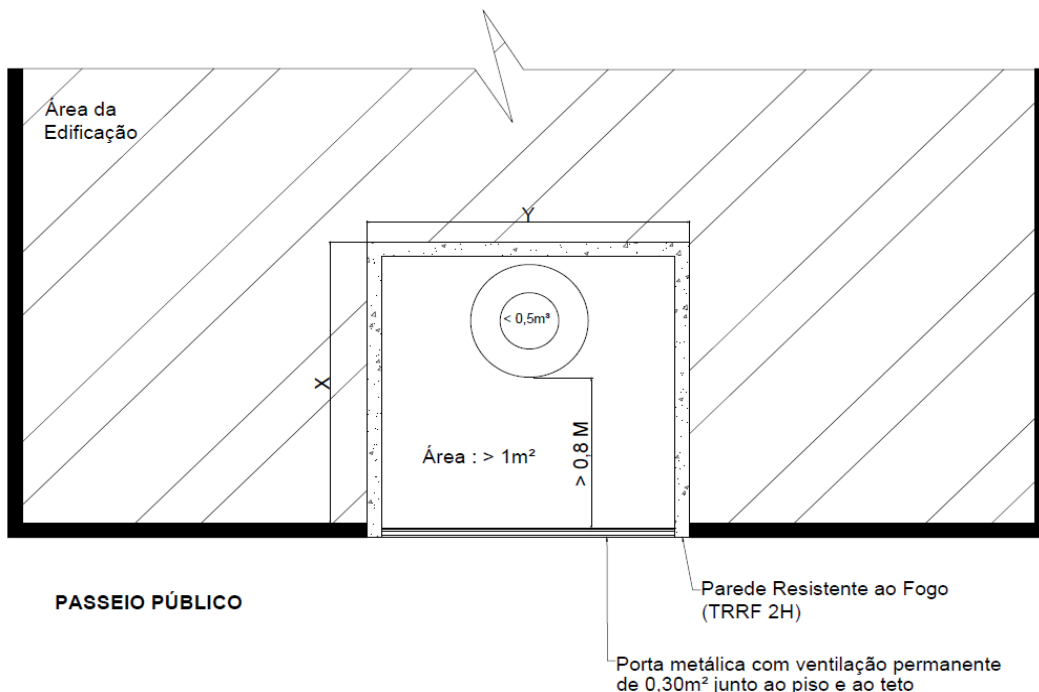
Detalhe em planta baixa de uma central de gás em nicho.
